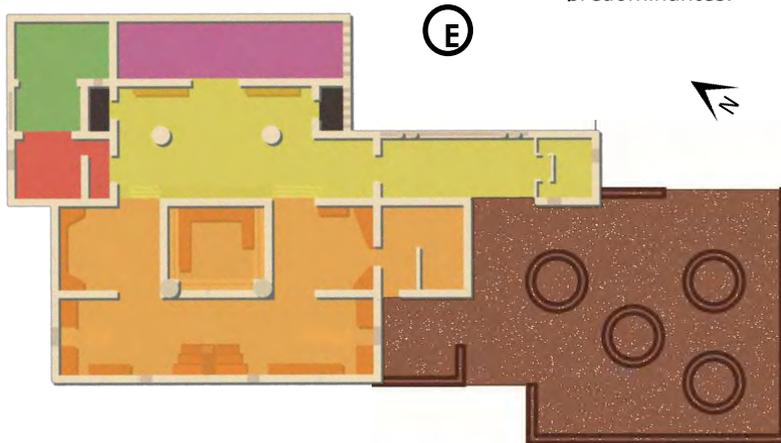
Planta arquitectónica del Museo de Sitio de Monte Albán.
